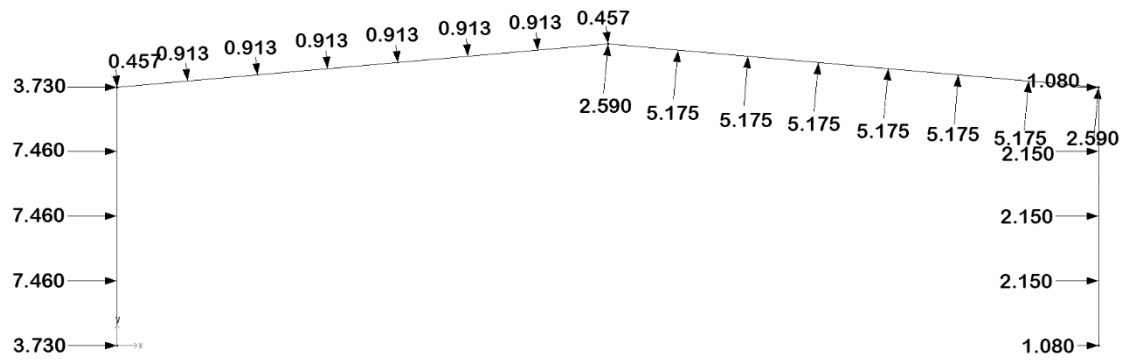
Esquema das cargas aplicadas no pórtico devido ao vento transversal, com cobertura a pressão e sucção.
